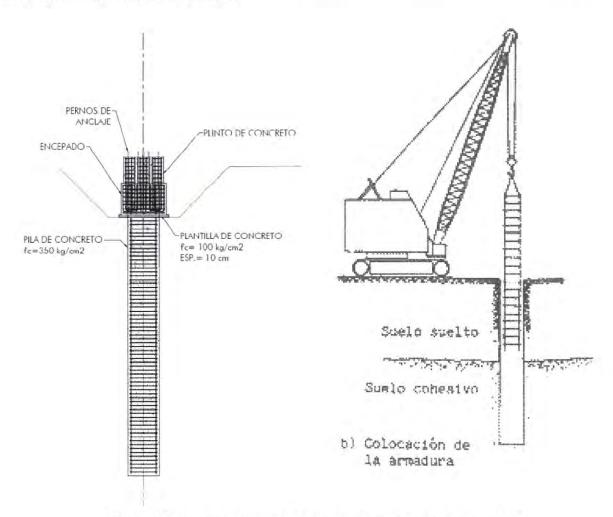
Armado de cimentación a base de pilas y colocación de la armadura.
